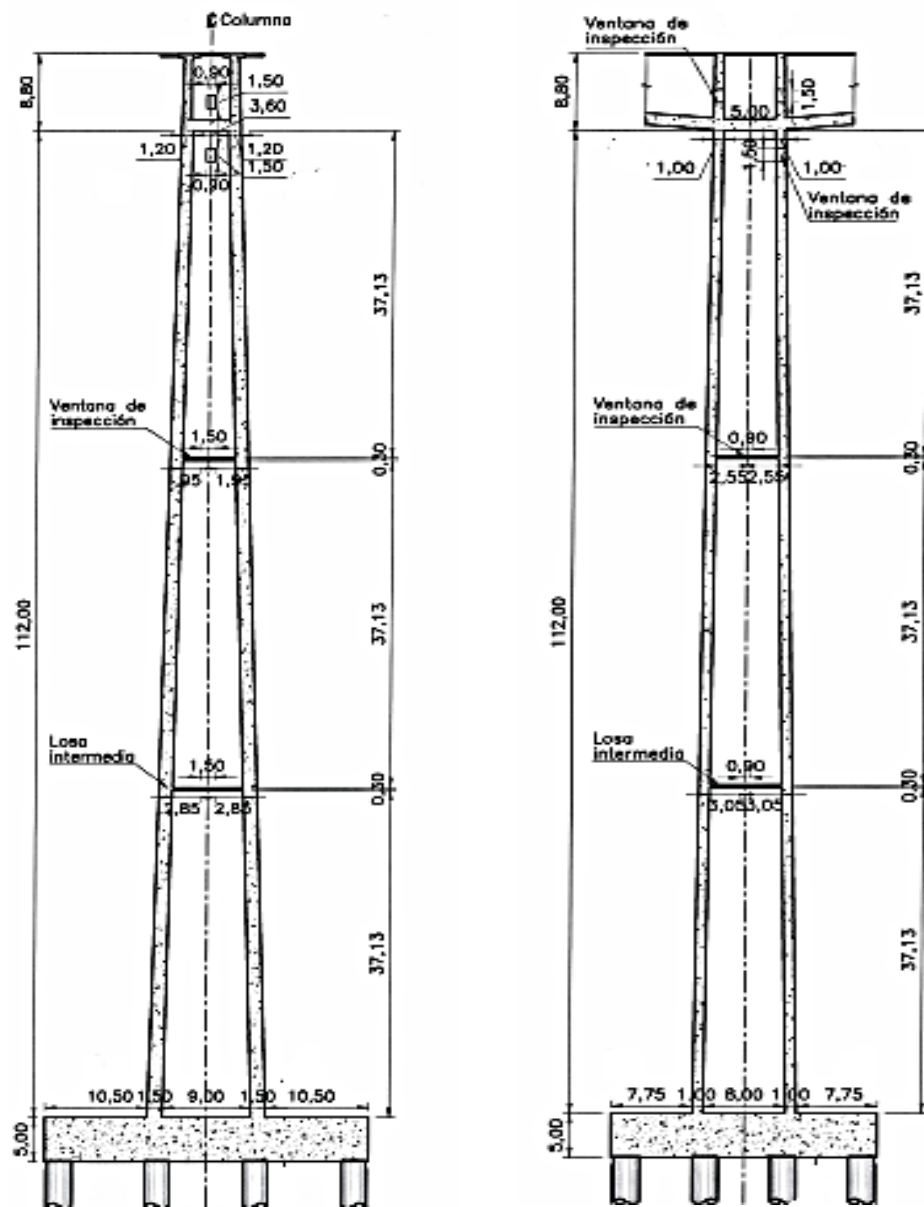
Sección pilas (transversal lado izquierdo, longitudinal lado derecho).
